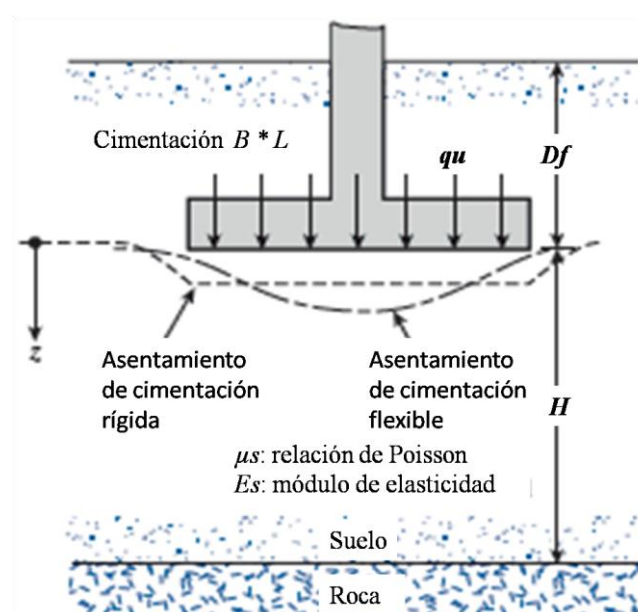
Asentamiento elástico de cimentación flexible y rígida. Fuente: Braja Das M., Principios de la Ingeniería de Cimentaciones.
